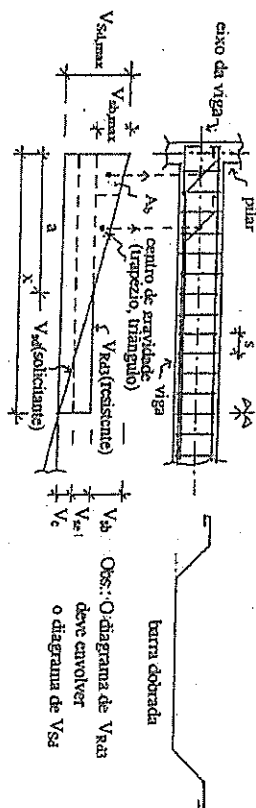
Diagramas de força cortante de cálculo no caso de armadura constituída por estribos verticais e barras dobradas a 45°
